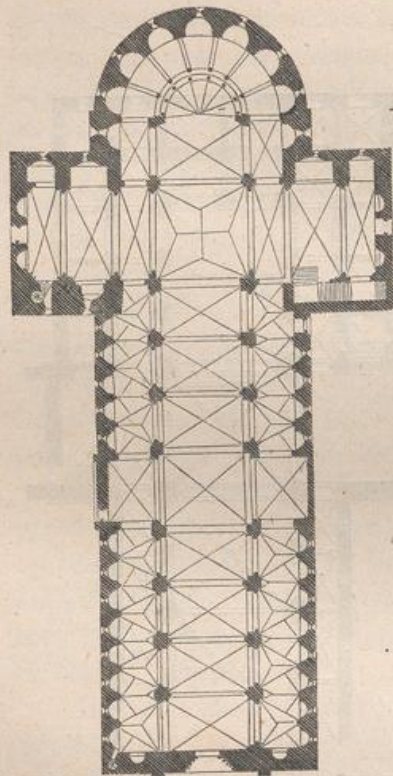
Kirche zu Heisterbach. Grundriss.
